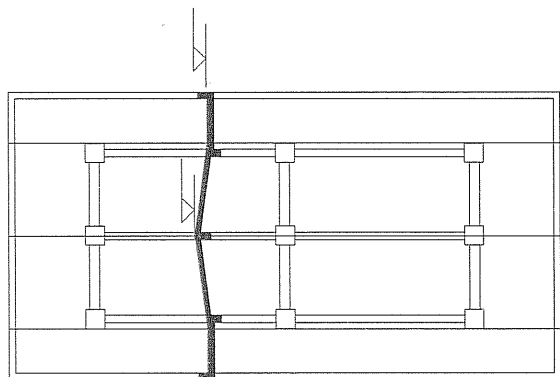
结构平面图中断面编号顺序表示方法
